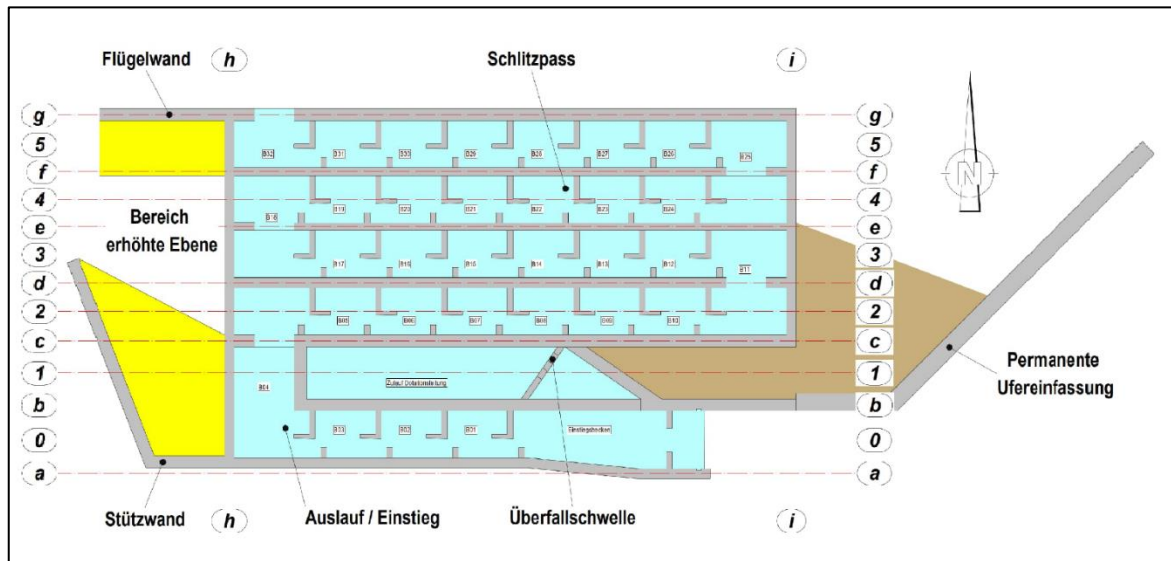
Grundriss Einstiegsbauwerk – Achseneinteilung
